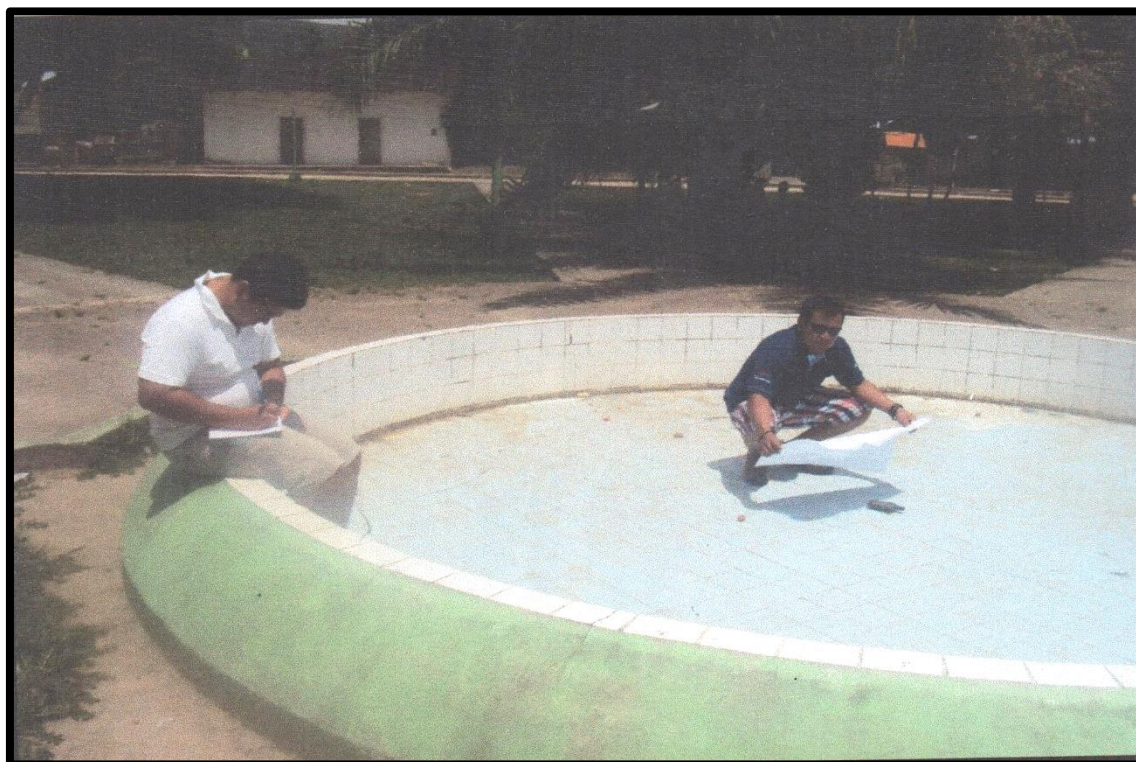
y 2. Se puede apreciar al Tesista Bachiller Ingeniería Civil ALCIDES MOREY RIVA, recopilando información geodésica con el empleo del GPS en la plaza de armas de la localidad de San Roque de Cumbaza.
